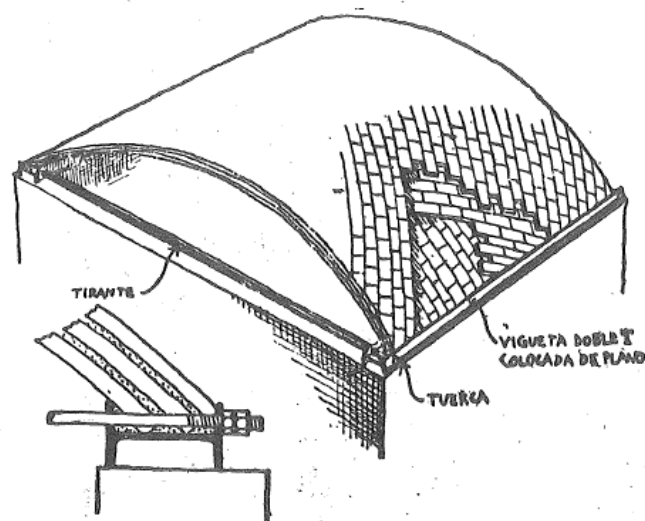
Bóveda cilíndrica sobre cuadrado o rectángulo, con estribo en los muros laterales y tirante oculto en los muros de testa. El estribo trabaja como una viga apoyada con carga uniforme, que es el empuje de la bóveda.
